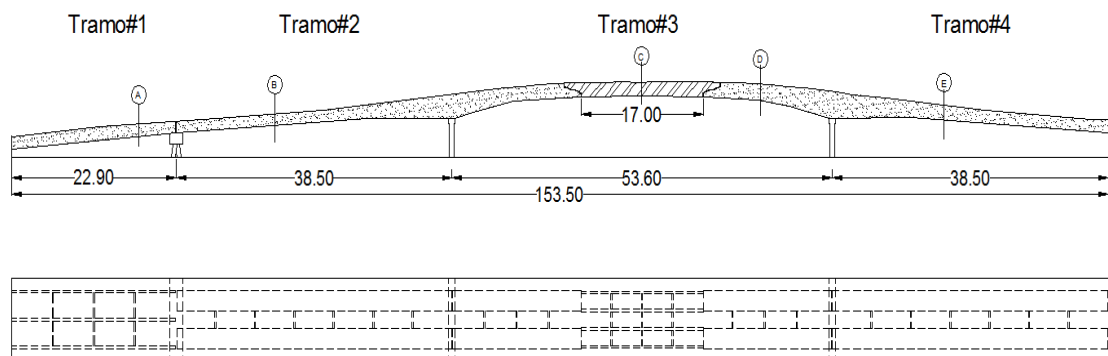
Vista longitudinal y en planta del puente de Tarifa.
